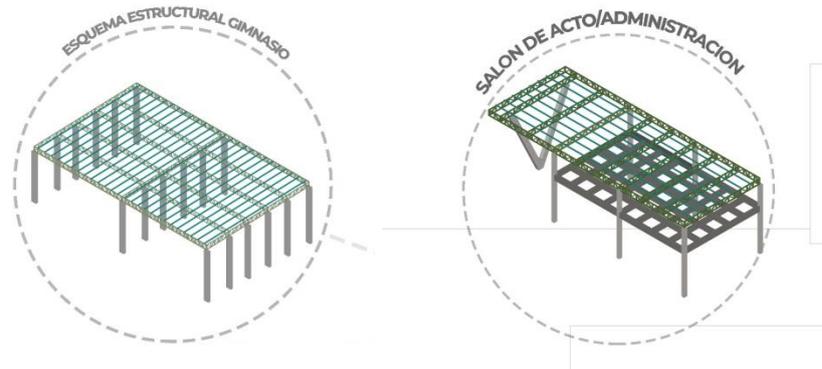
Esquema estructural. Indicado en color verde, la estructura metálica y en color gris, el hormigón
